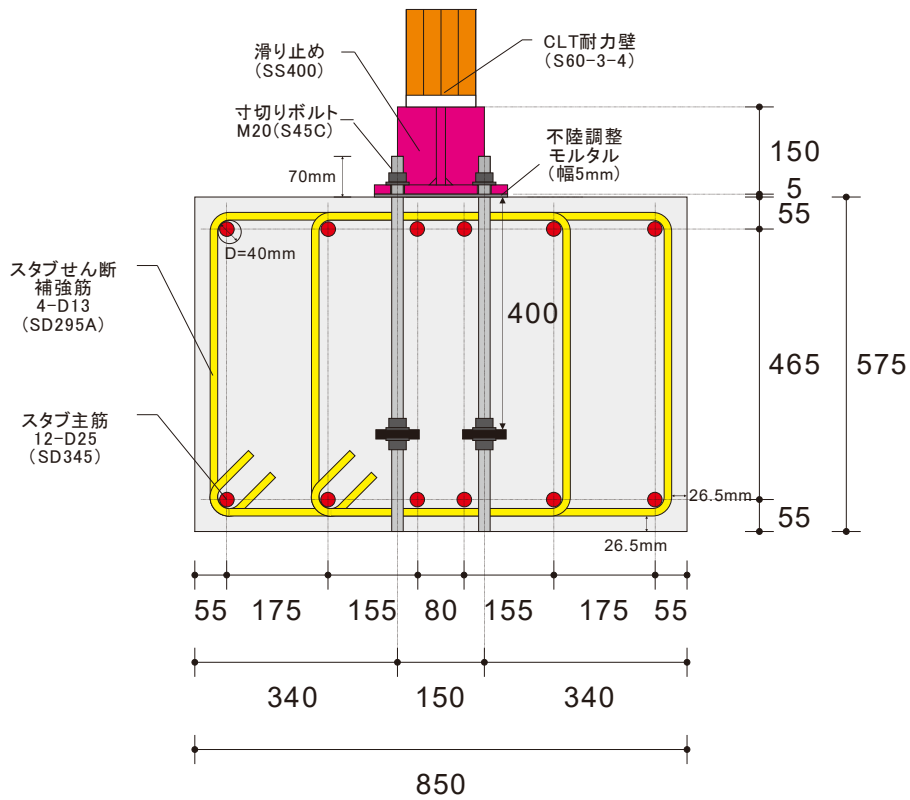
試験体 WA の CLT 耐力壁取り付け後のスタブの断面図
